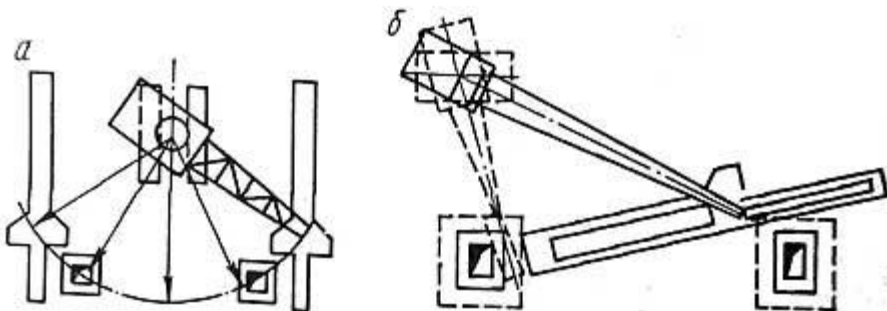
Способы подъема железобетонных колонн: а — легких; б — тяжелых
